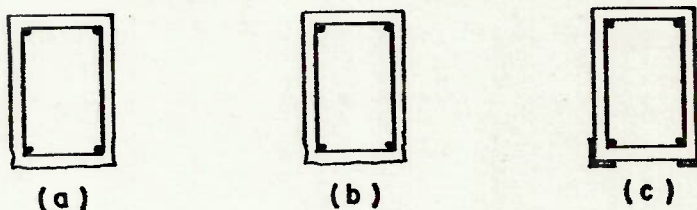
Reforço de viga mediante colagem de cantoneira de aço
